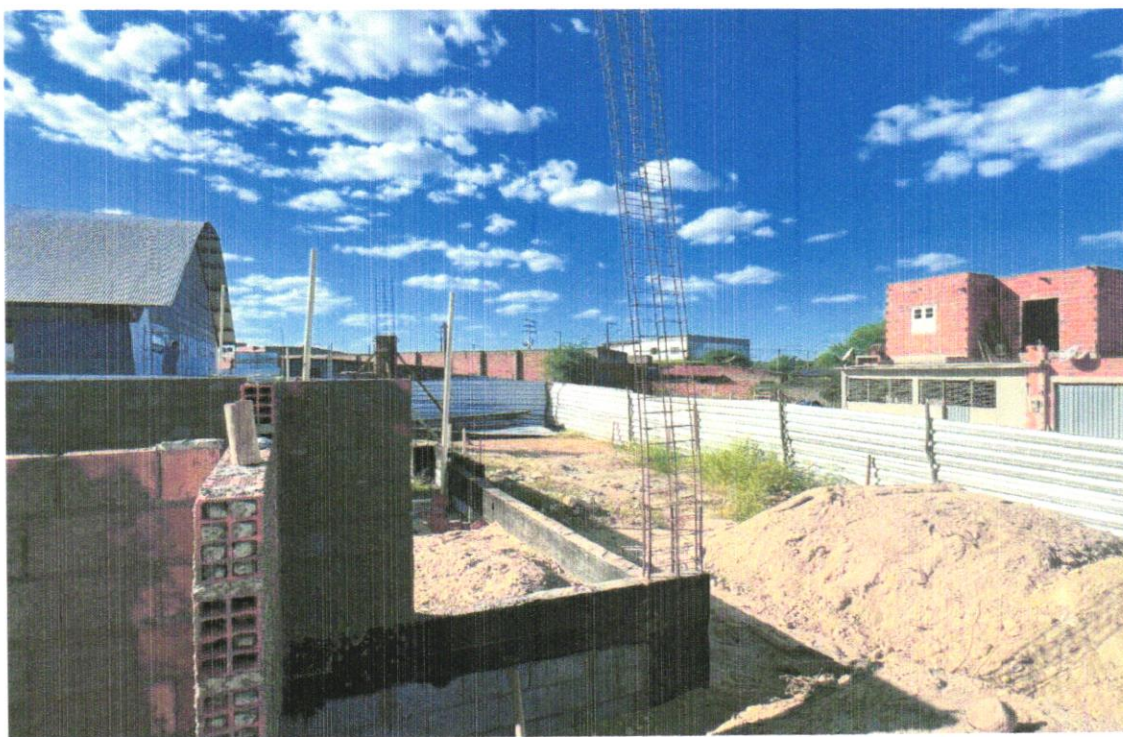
Armação de aço CA-50 Ø 8mm; incluso fornecimento, corte, dobra e colocação
